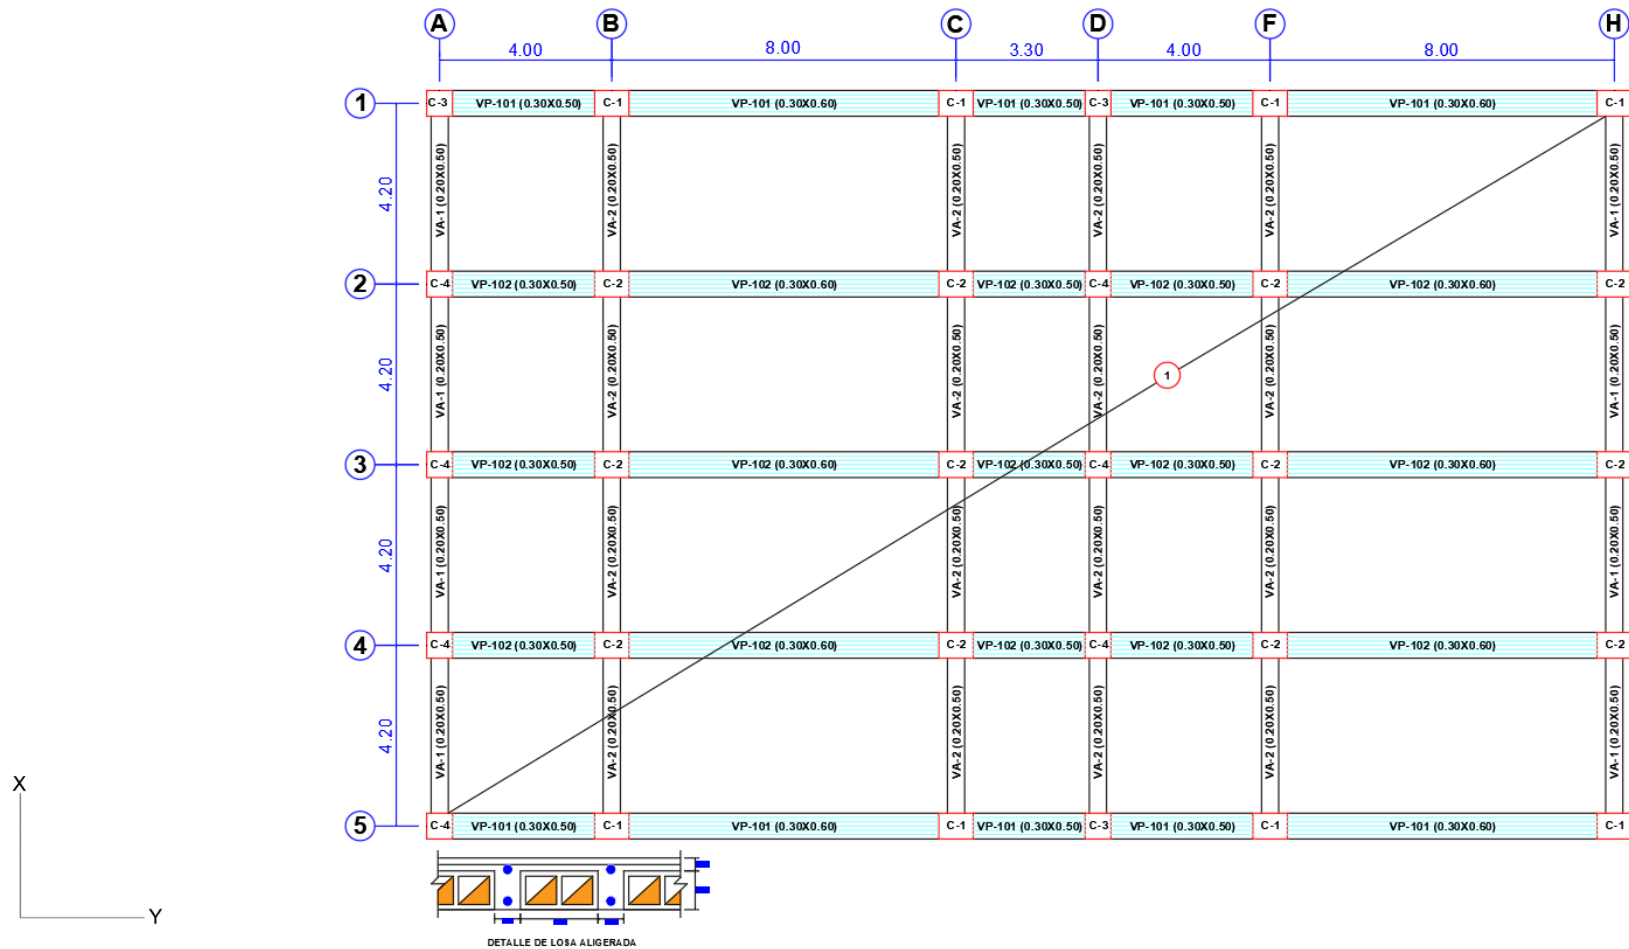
Distribucion de los elementos estructurales del Primer Nivel (Fuente: Archivos del Área de Archivo Central, de las obras ejecutadas en la Universidad Nacional de San Martín – Tarapoto)
